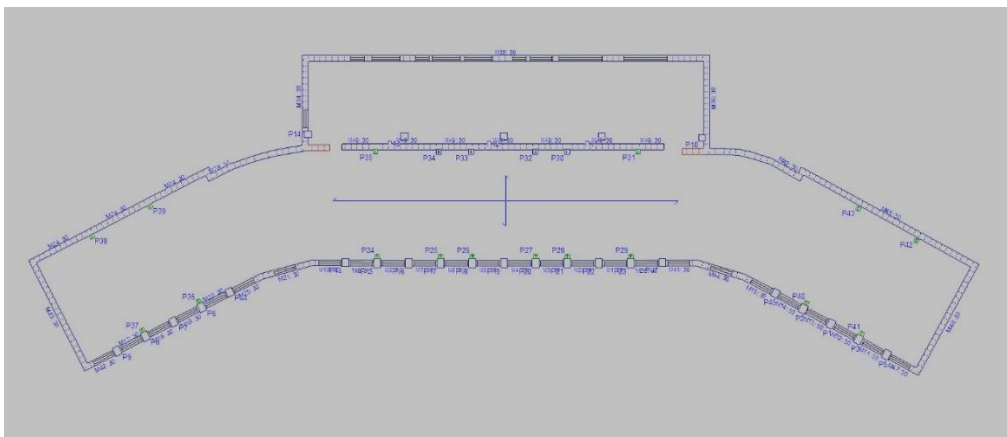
Planta 4 del modelo de 5 plantas simplificado
